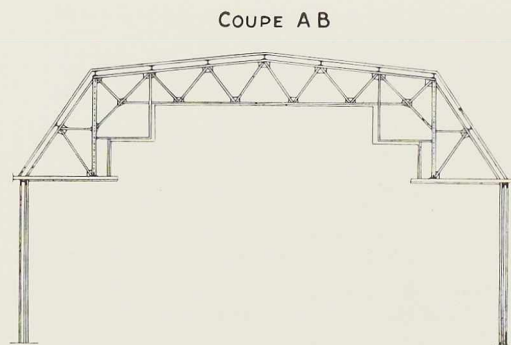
Coupe transversale dans la charpente de toiture du Théâtre Rembrandt à Utrecht.
